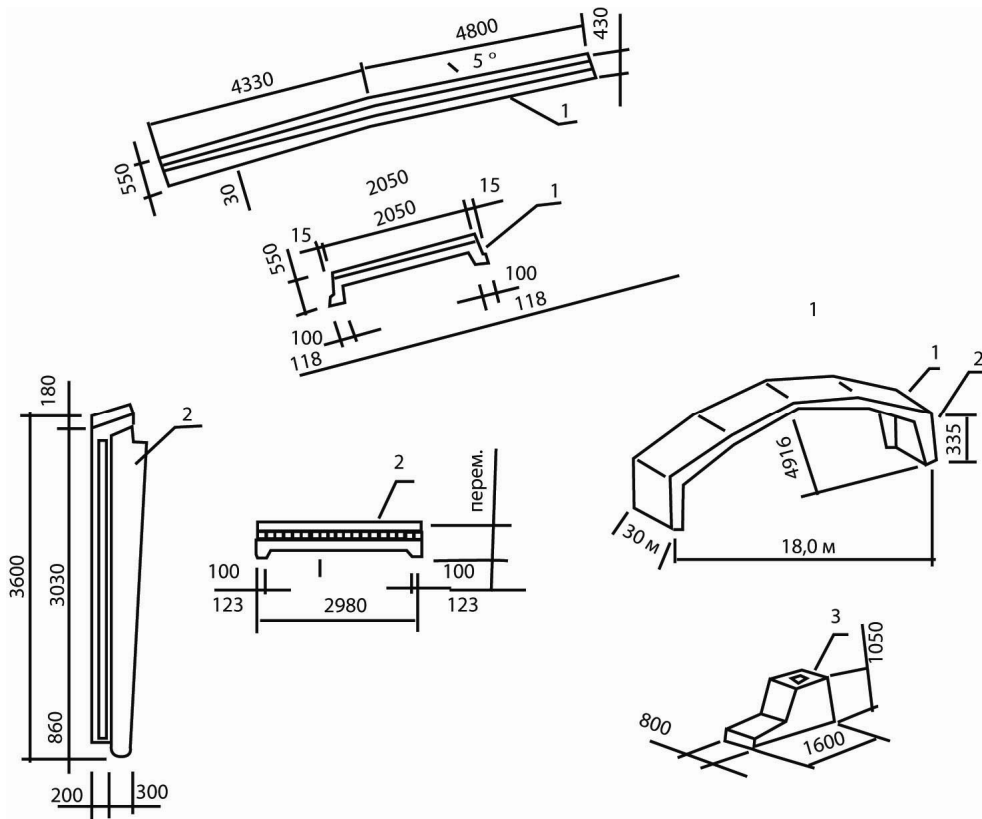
Схема об'ємного блоку 3x18м, його елементів і фундаменту:
